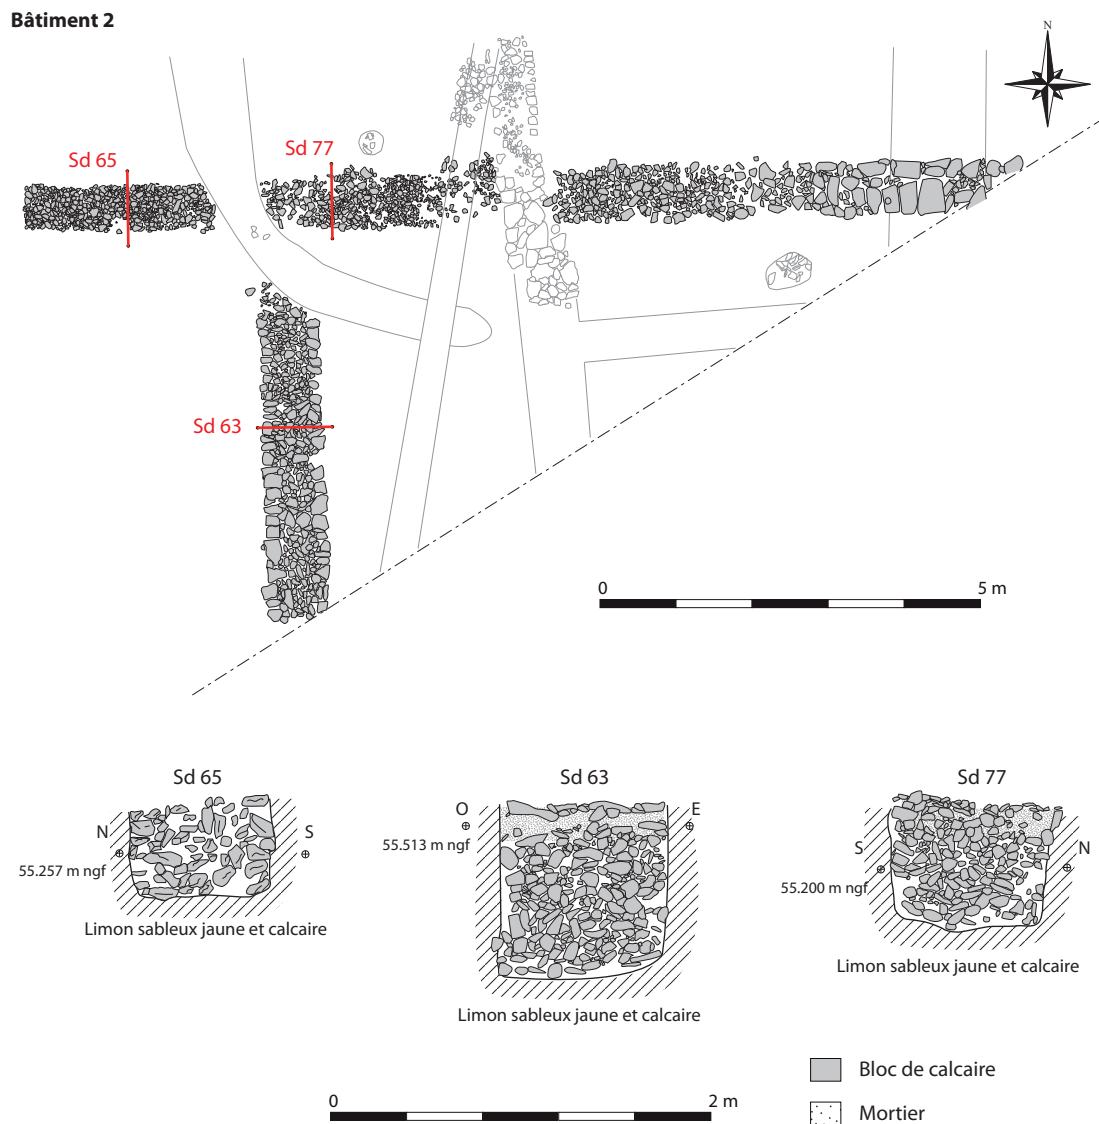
Plan et coupes du bâtiment 2 © A. Guicheteau.
